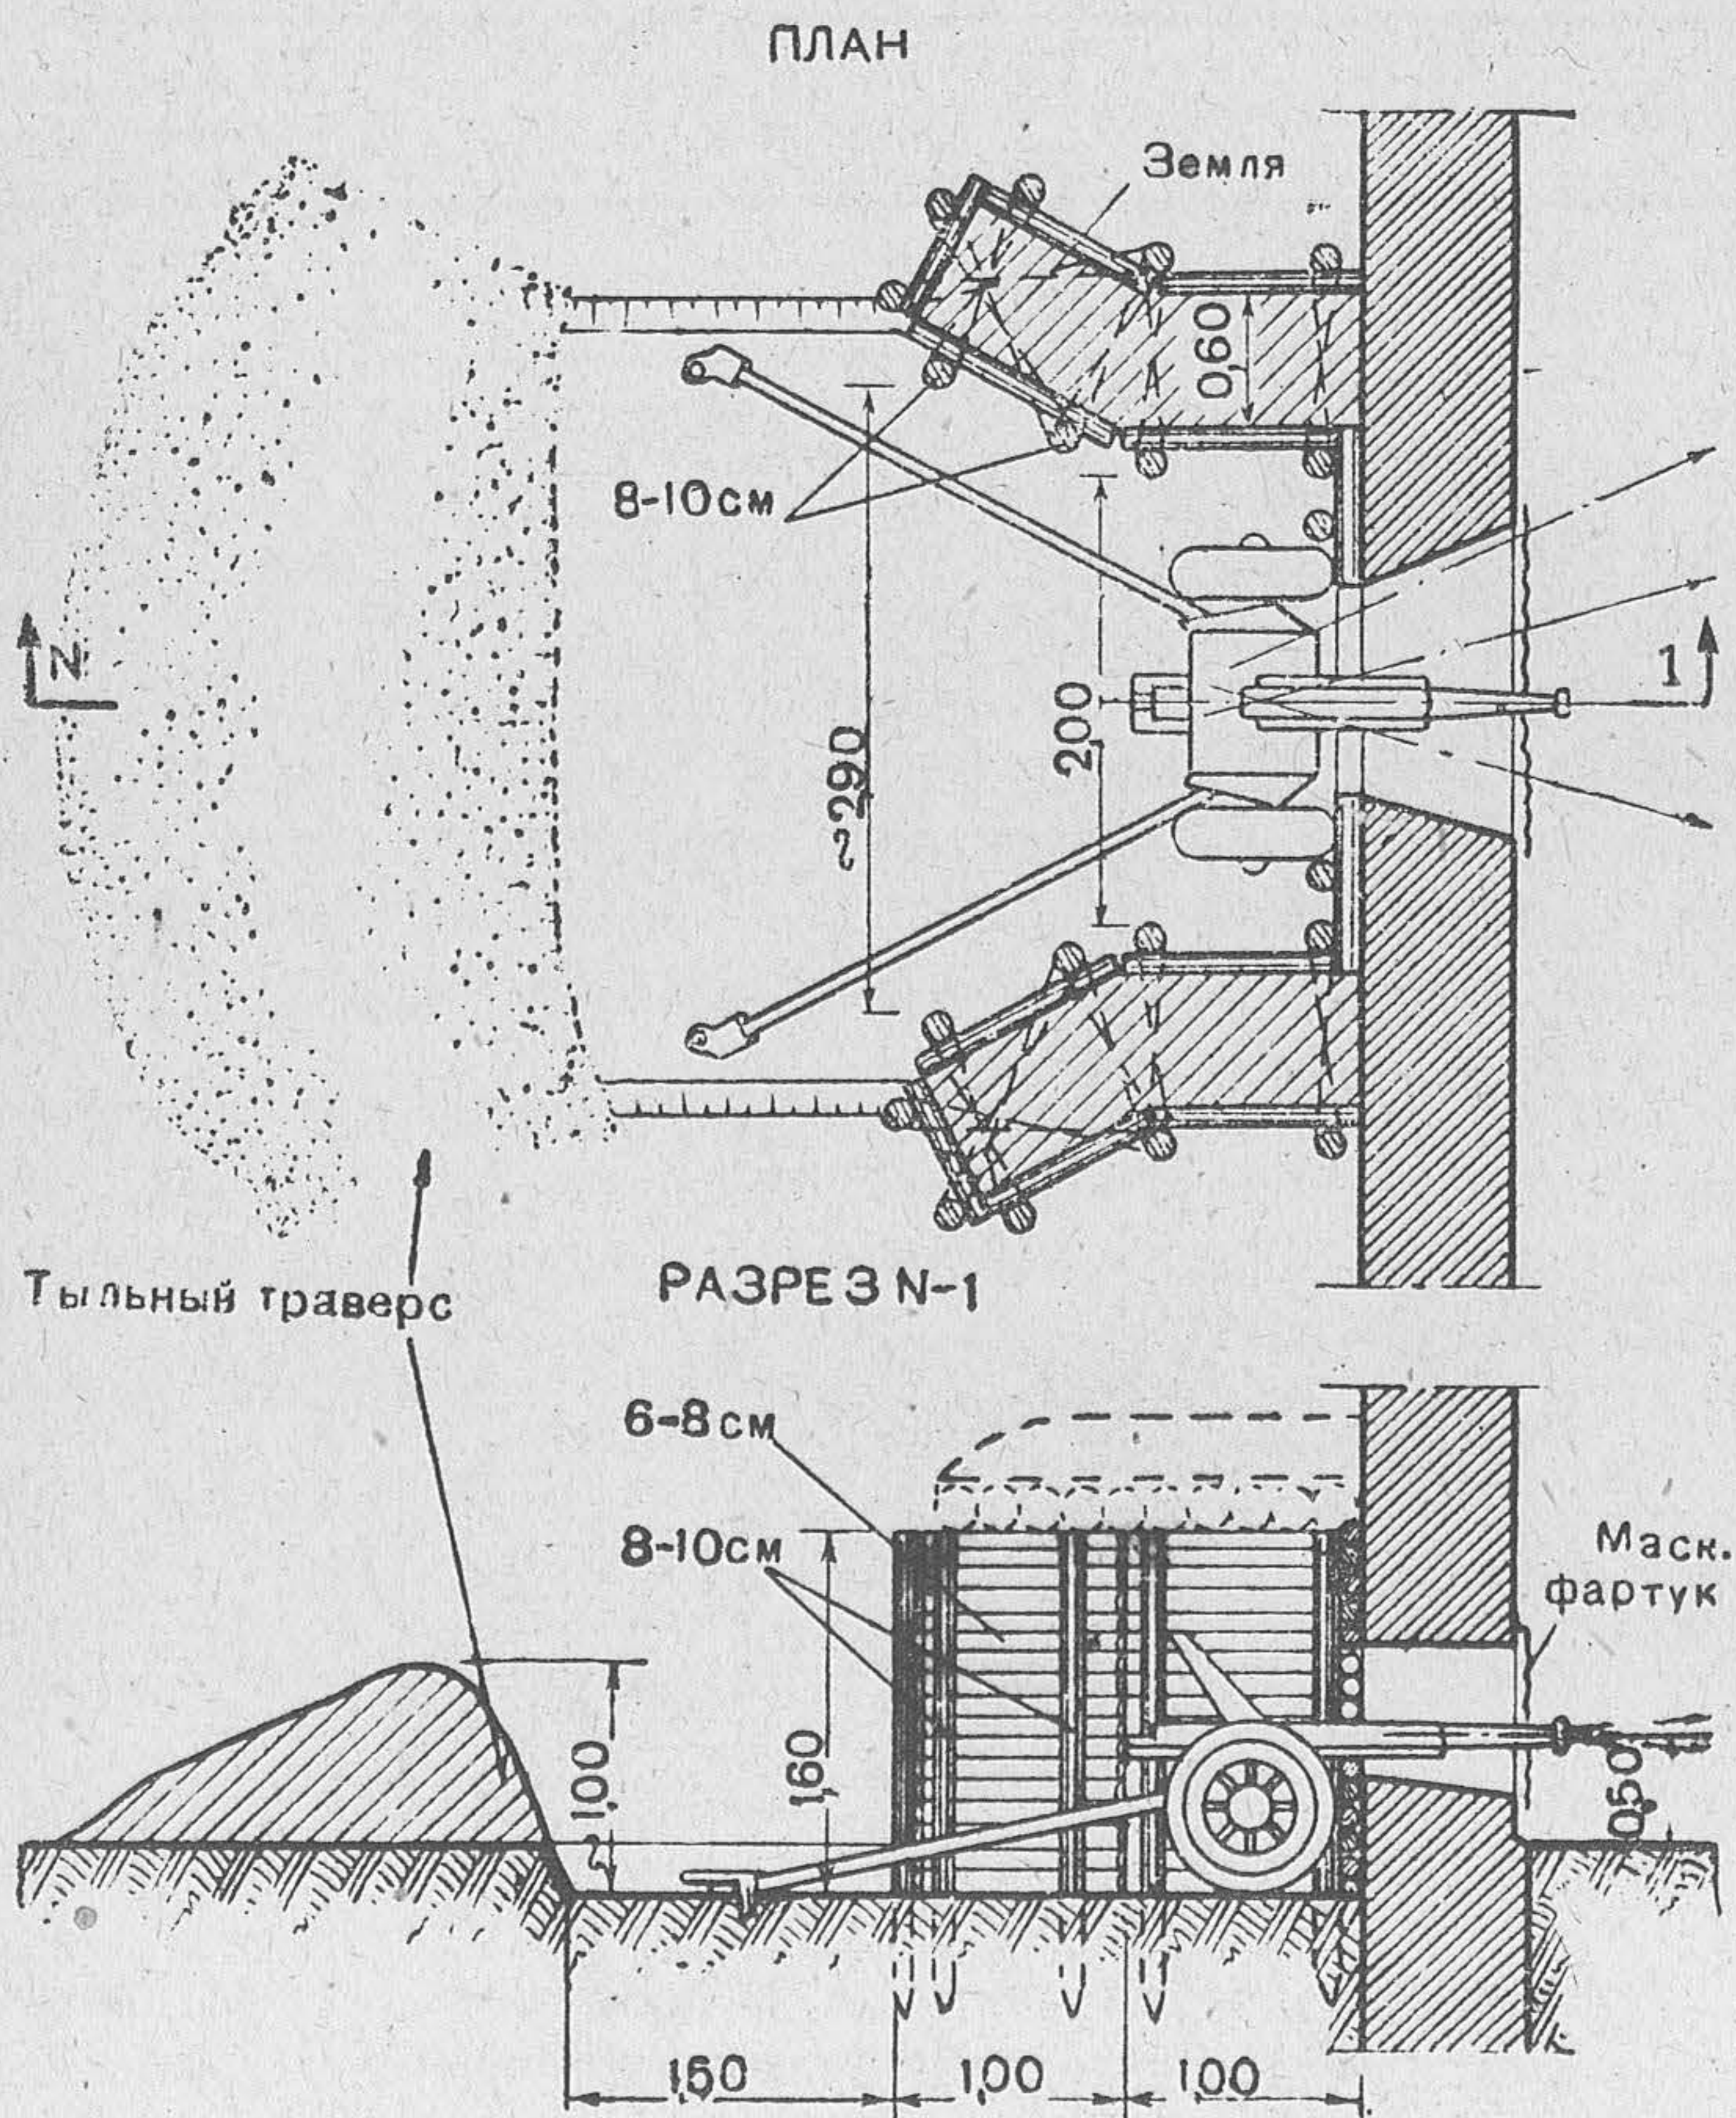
Приспособление каменной стены для установки 45-мм пушки
